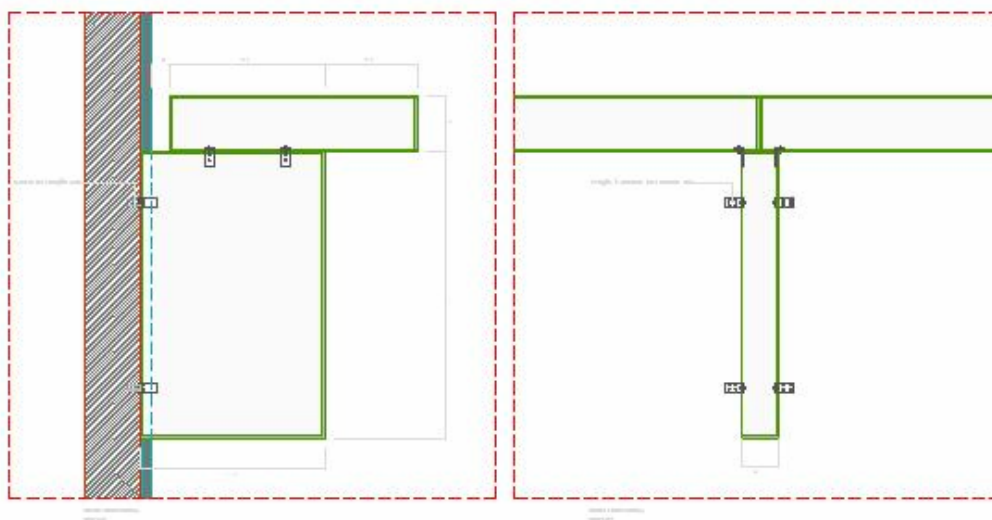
Pormenor construtivo dos elementos “brise-soleil”.
